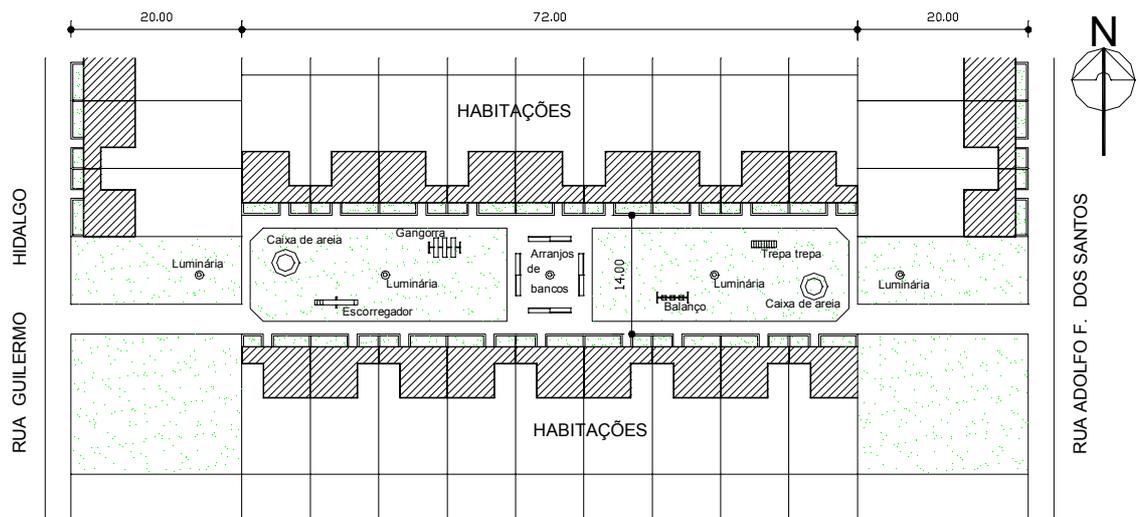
Planta Original do Espaço Aberto Comum 3 do CHST
